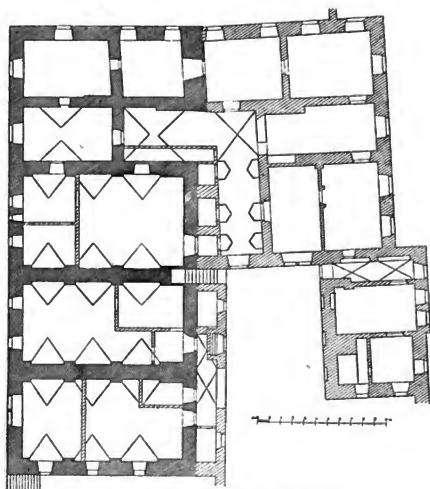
Štáhlau. Grundriss des alten Schlosses.
